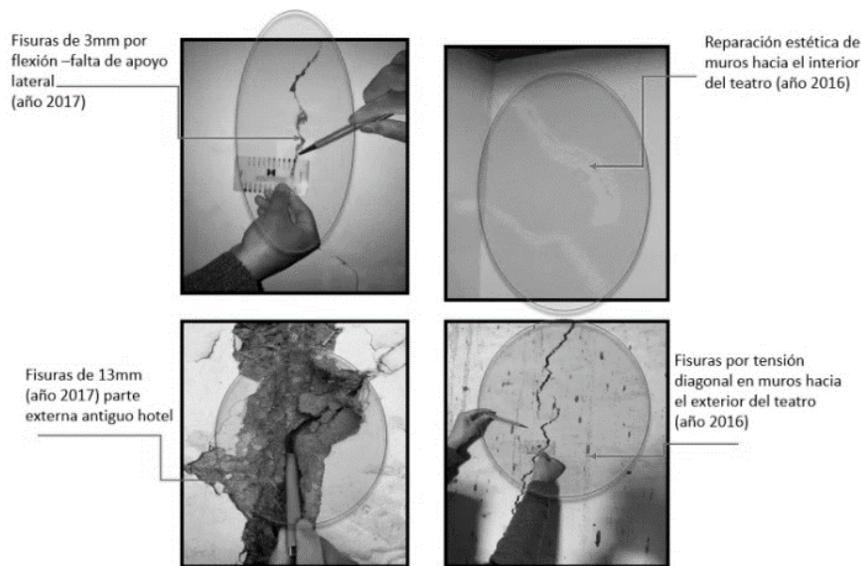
Grietas en la parte interna y externa del Teatro – maquillaje interno de grietas.
